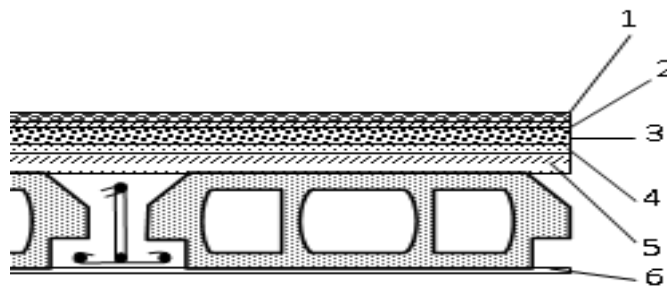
Coupe transversale d'un plancher d'étage courant et du RDC.
